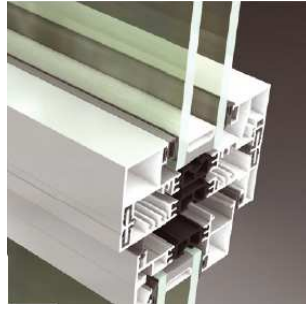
a-j Sistemas de Fachada Modular em Alumínio.
